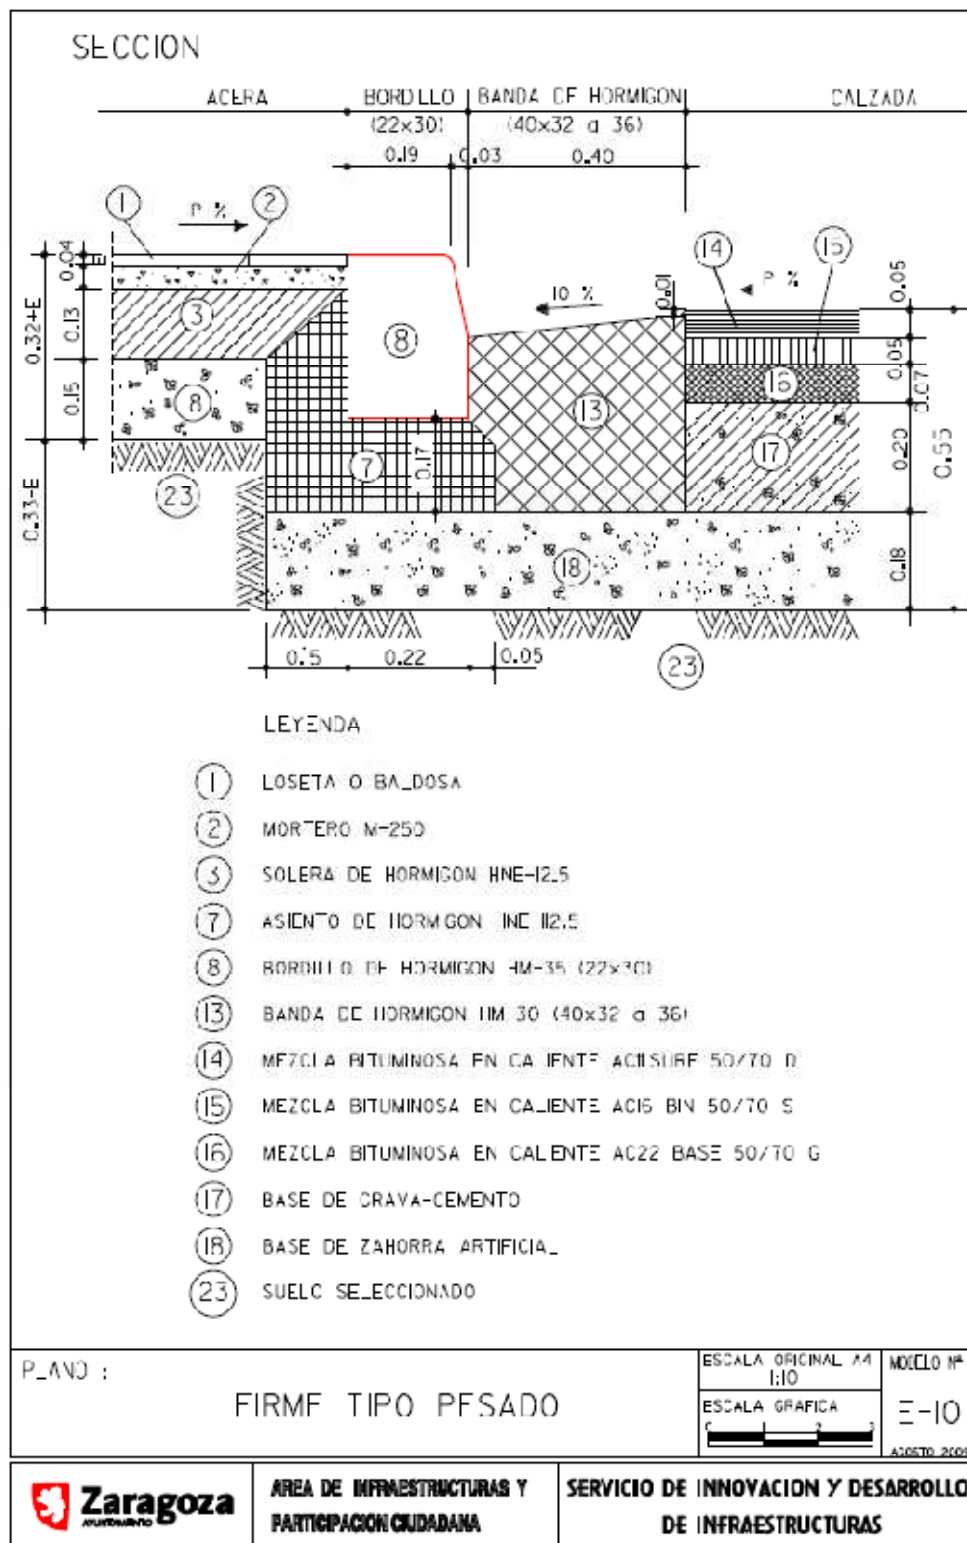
Sección tipo firme pesado E-10 (Fuente: Web Ayuntamiento de Zaragoza, julio 2010)
